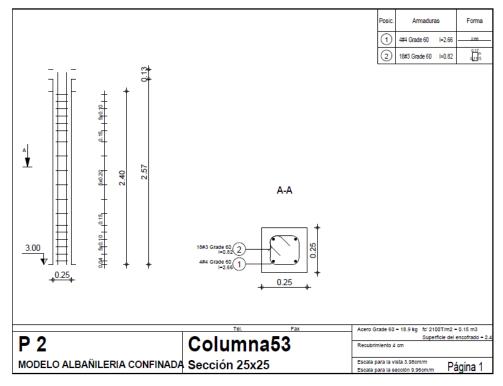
Plano de ejecución por defecto de la columna en Robot.
